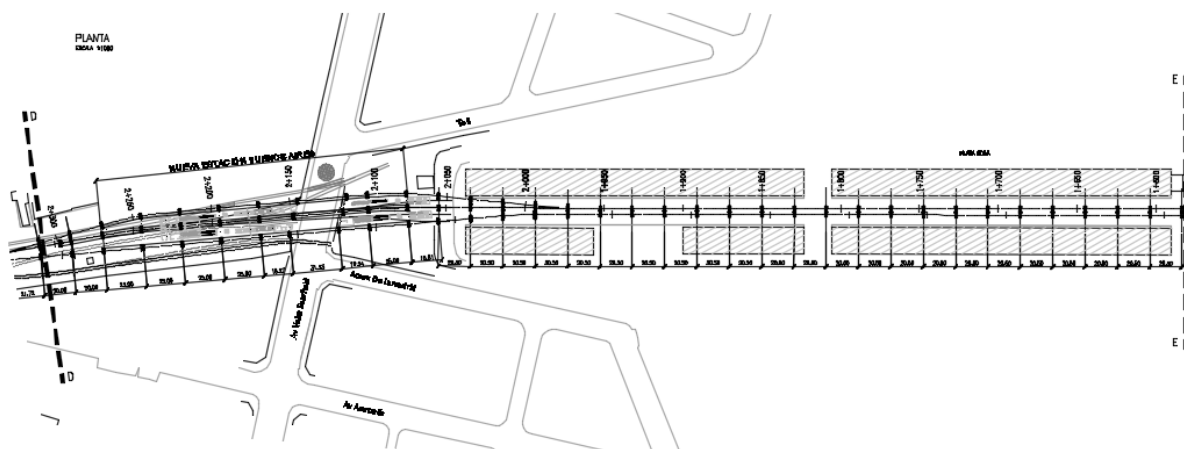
Tramo Estación Buenos Aires Elevada – Playa Sola
